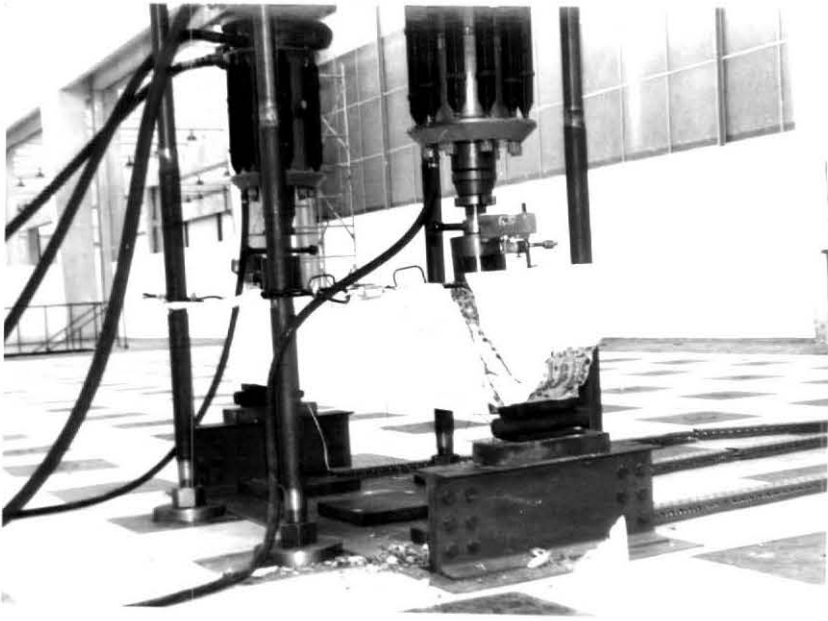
Vista da viga 8B ($a/d=0,8$) rompida por esmagamento da biela de concreto.
